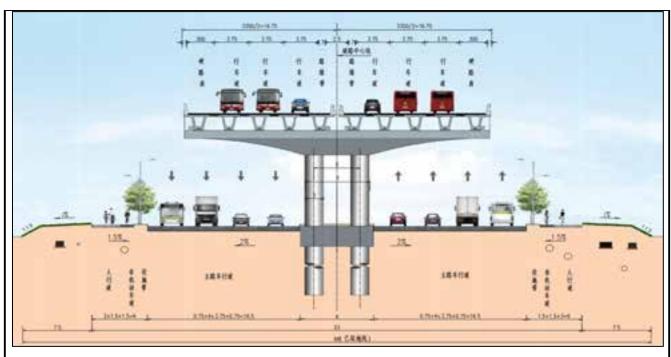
远期汕汾复线落墩(K26+826.979~K30+944.348)断面布置示意图
